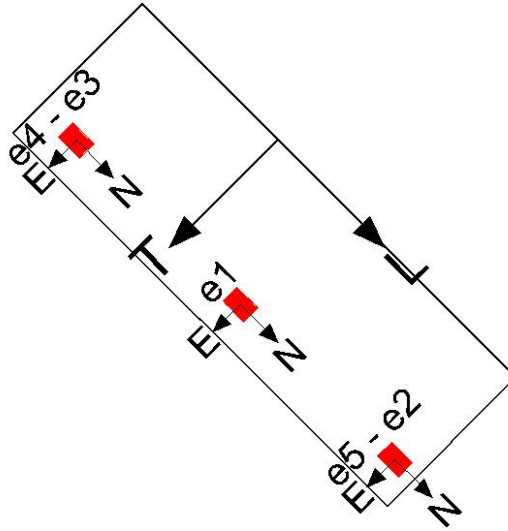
Vista en planta del edificio N°4. Ubicación, orientación y numeración de equipos utilizados
